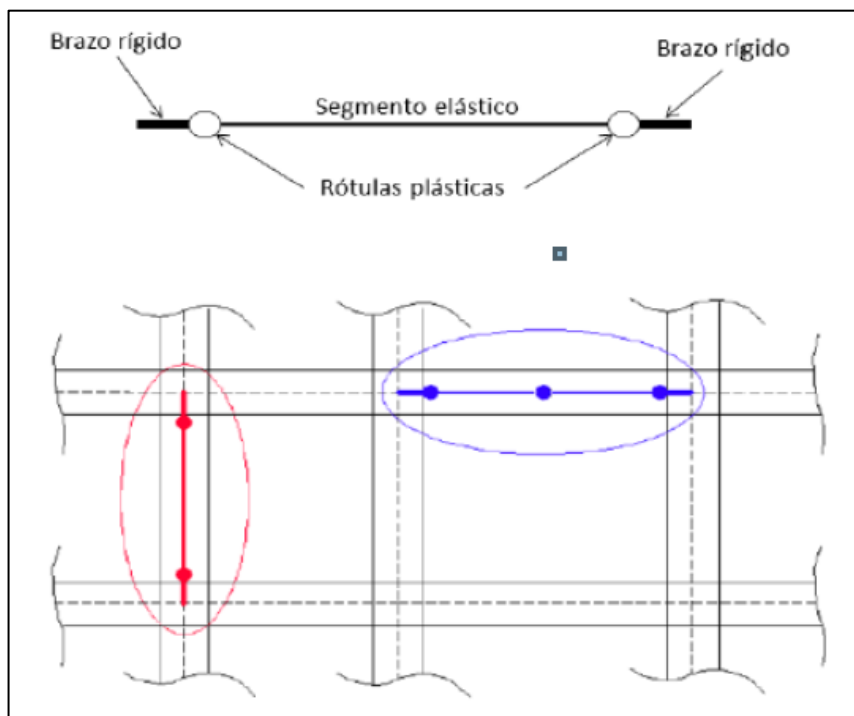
Modelado de rótulas plásticas en vigas y columnas. Fuente: ASCE 41-13.
